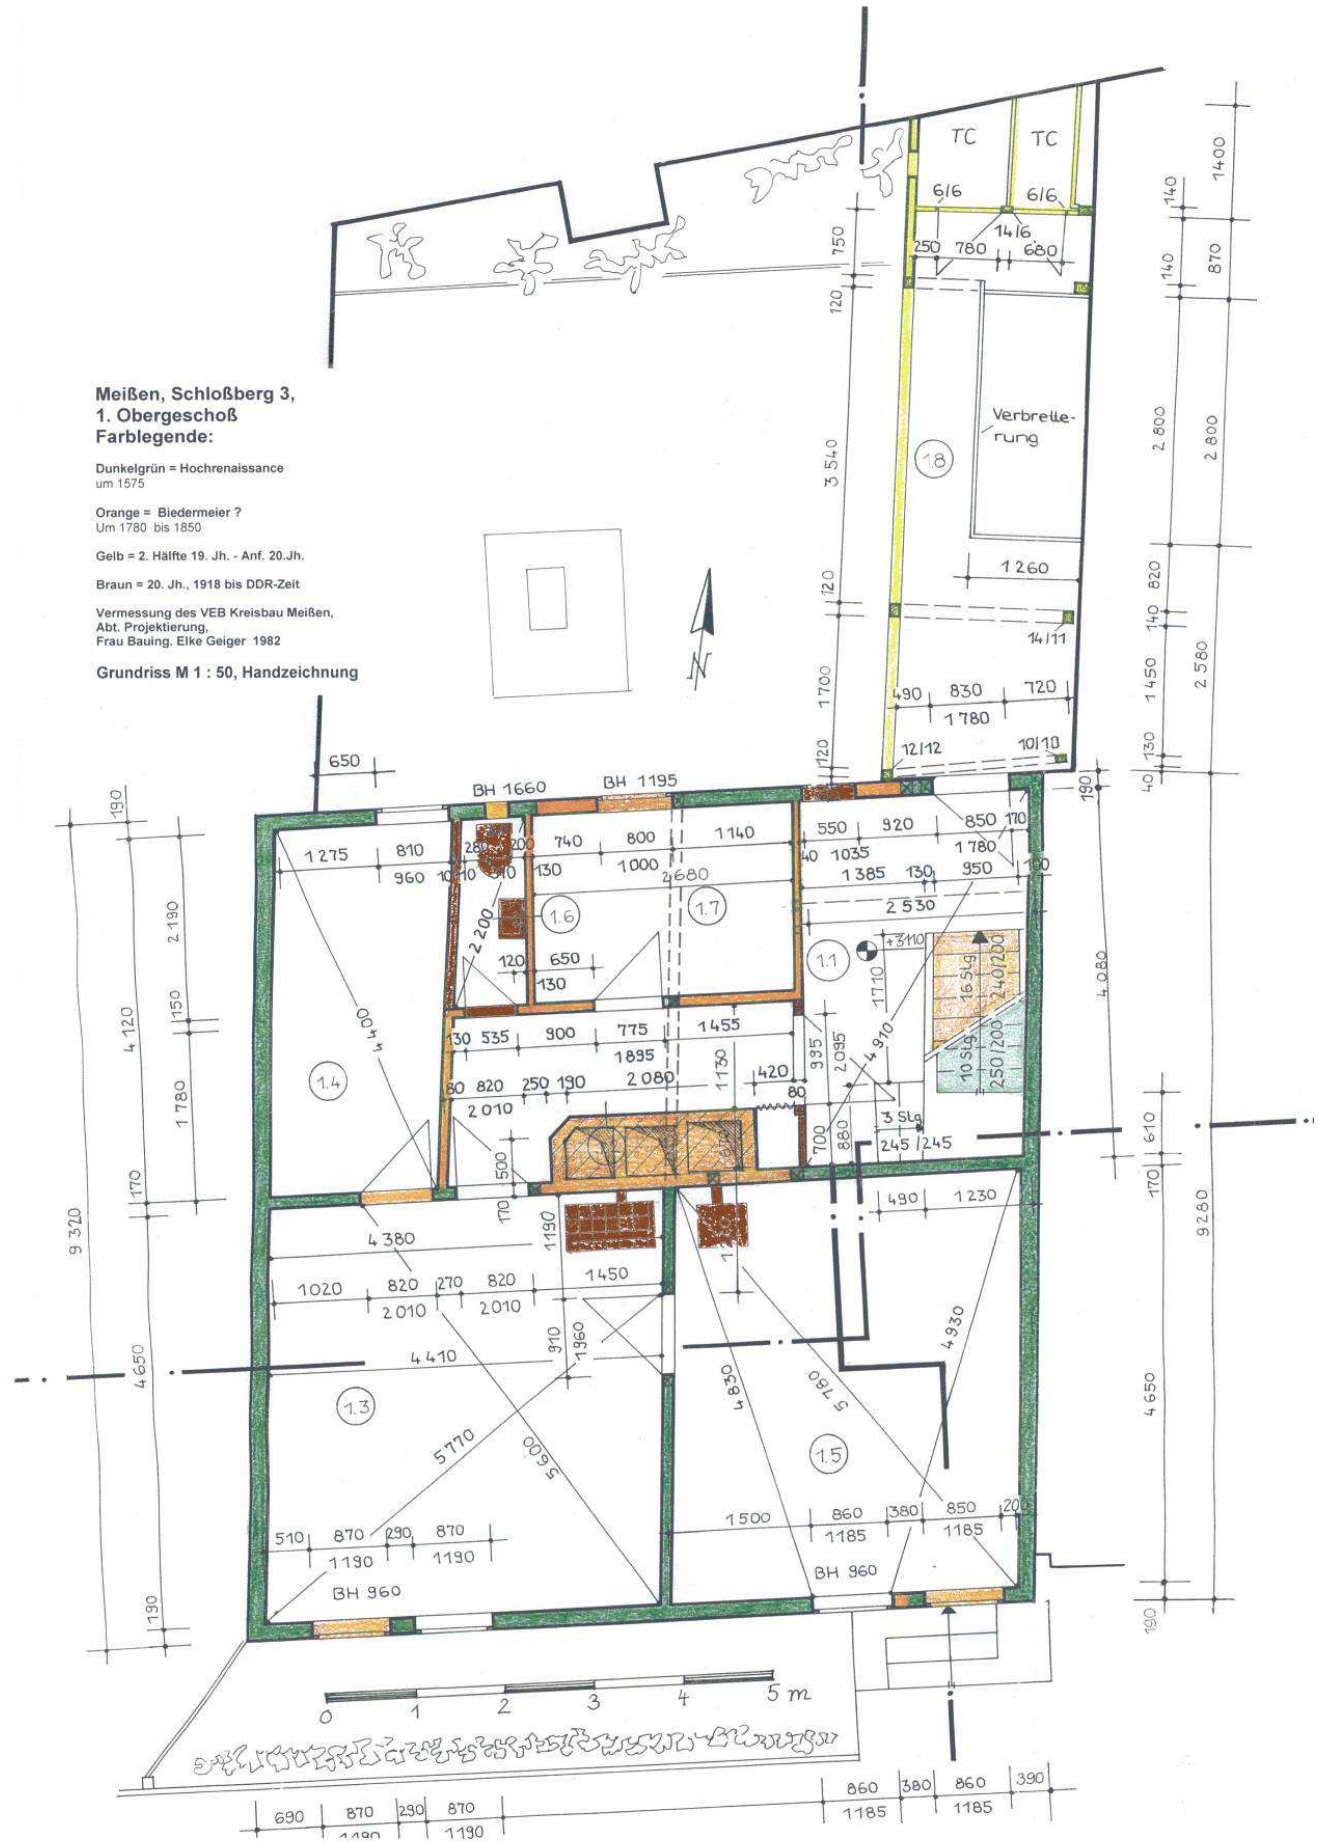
Schloßberg 3, Baualterplan 1.Obergeschoß
